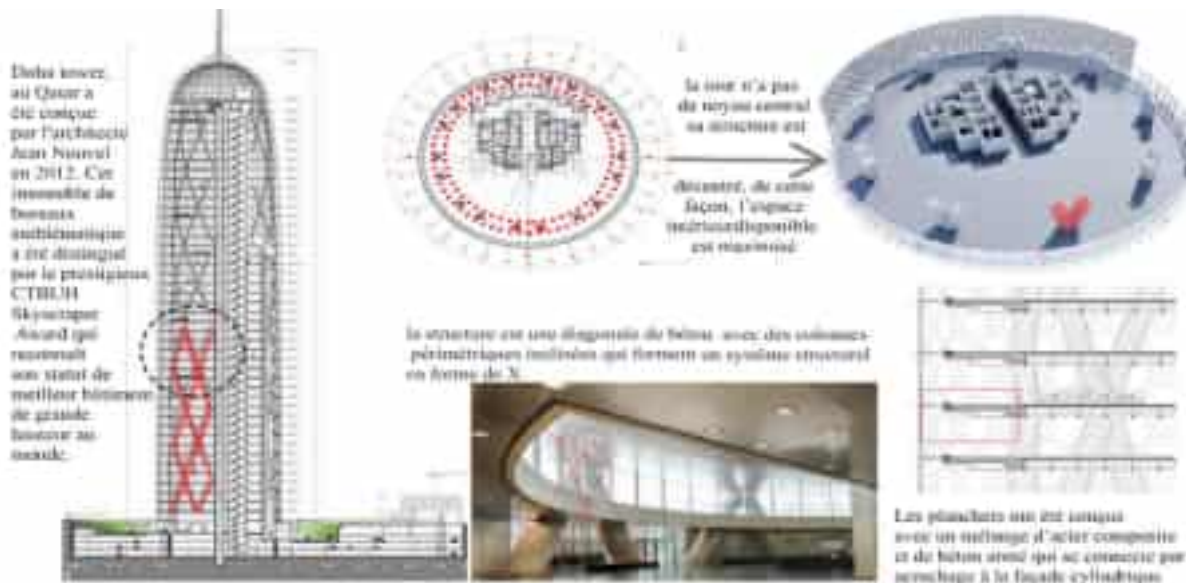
Doha tower par Jean Nouvel en 2012 / Source : auteur
